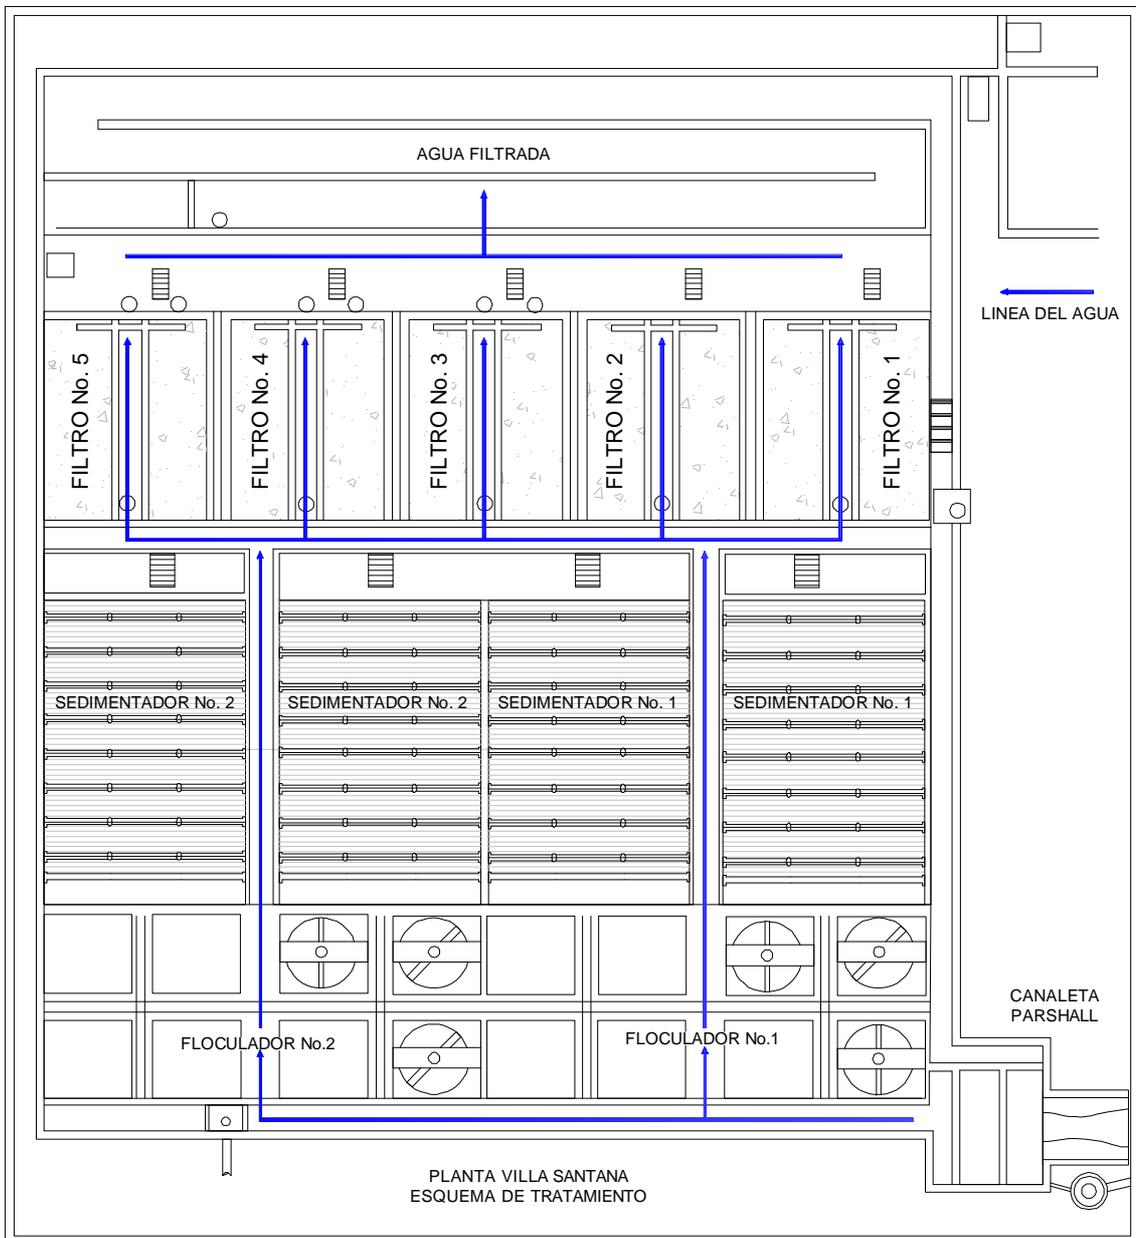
Esquema de los módulos de tratamiento – Planta de tratamiento Villa Santana
